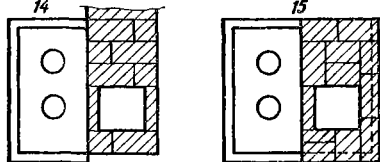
Отопительно-варочная печь с водонагревателем и духовым шкафом:
